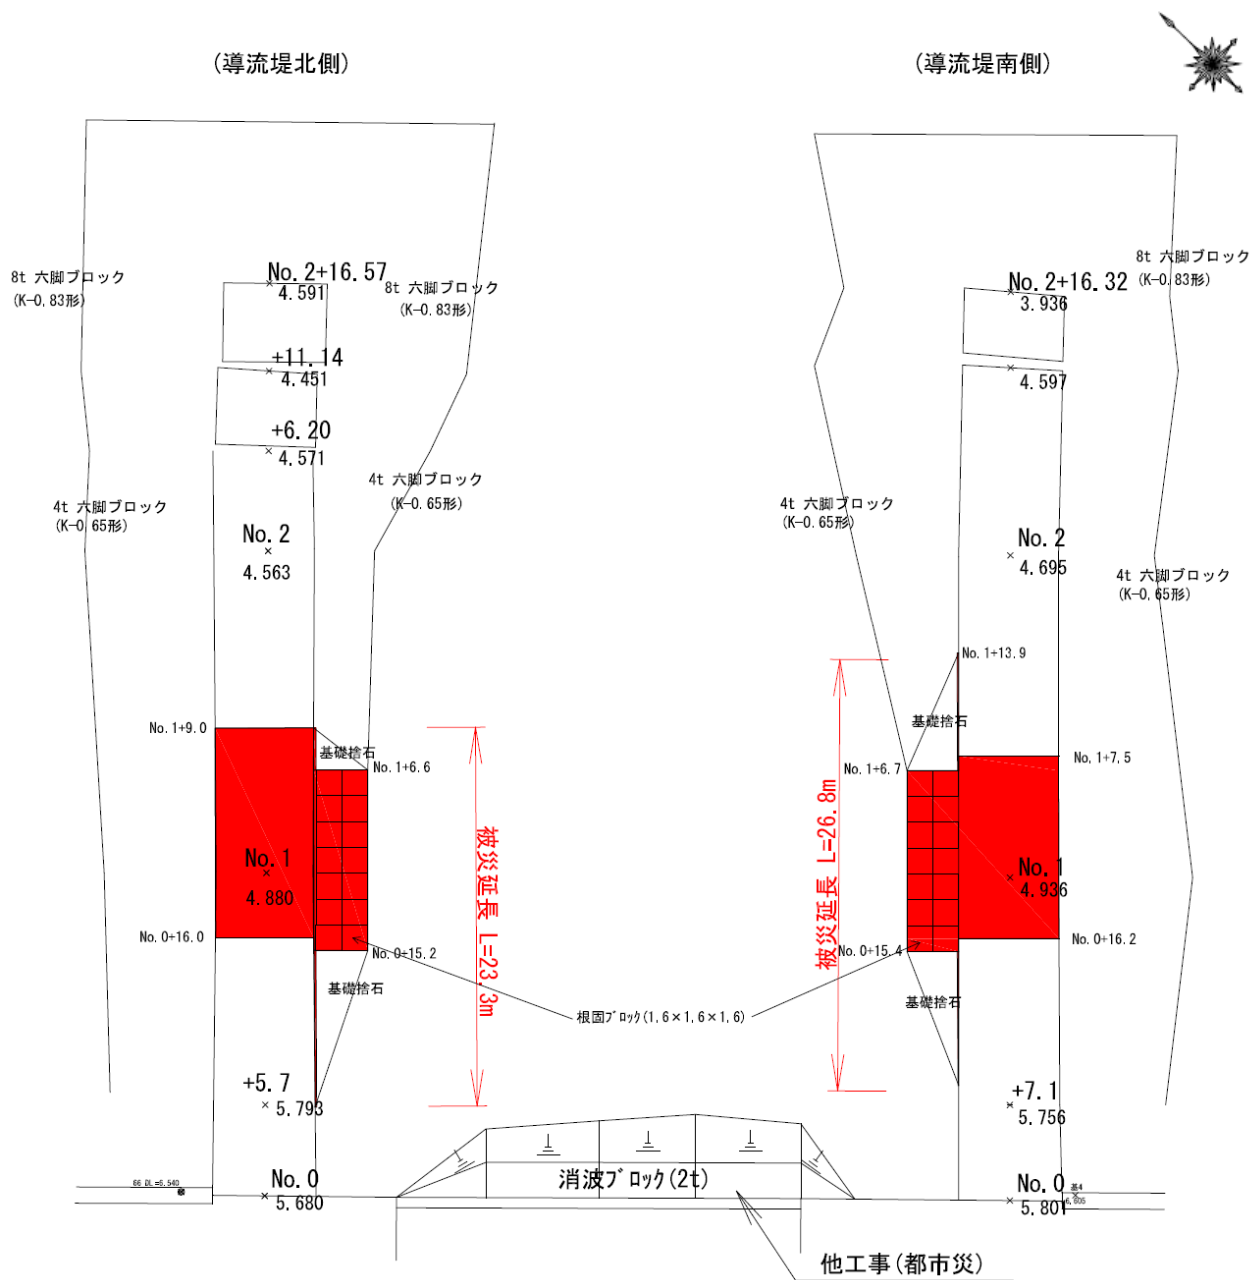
No.8 南海浜埋立地導流堤の平面図 (被災後)
